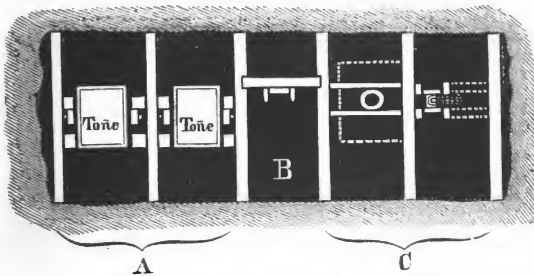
Grundriss desselben Tiefbauschachtes.
